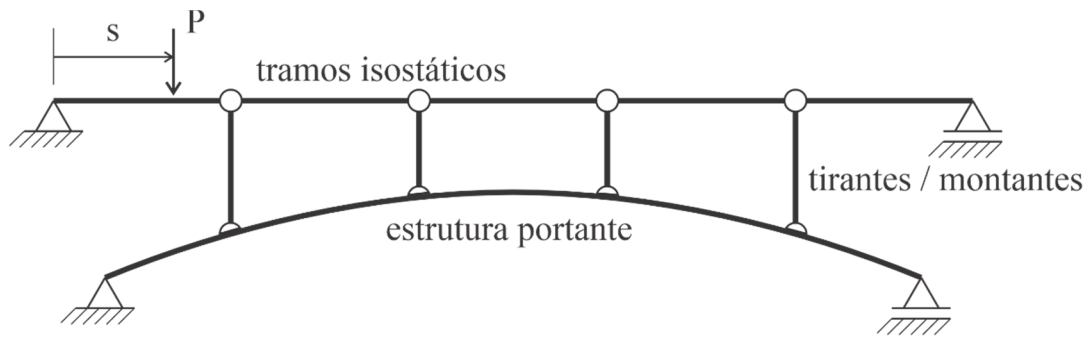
SISTEMA ISOTÁTICO DE PISO.
